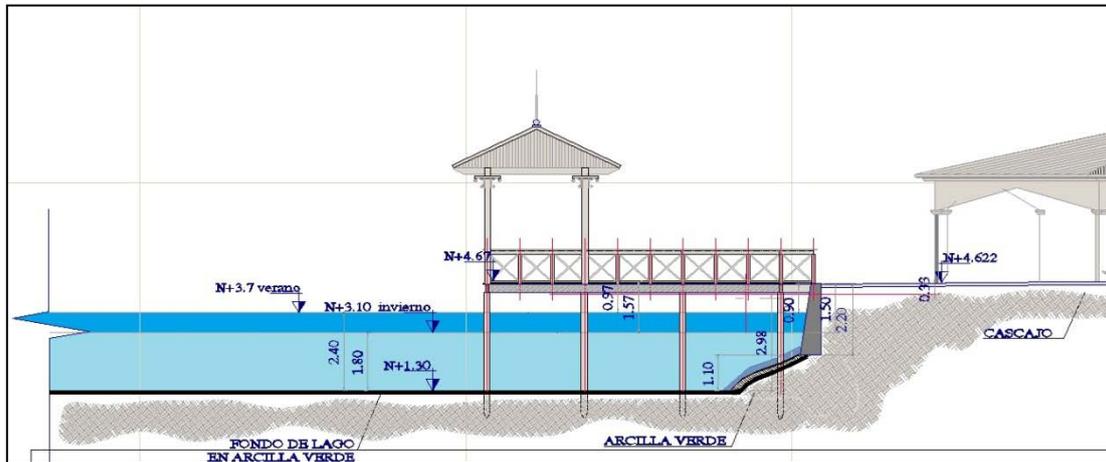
ESTRUCTURA TRASVERSAL DEL LAGO (2)
